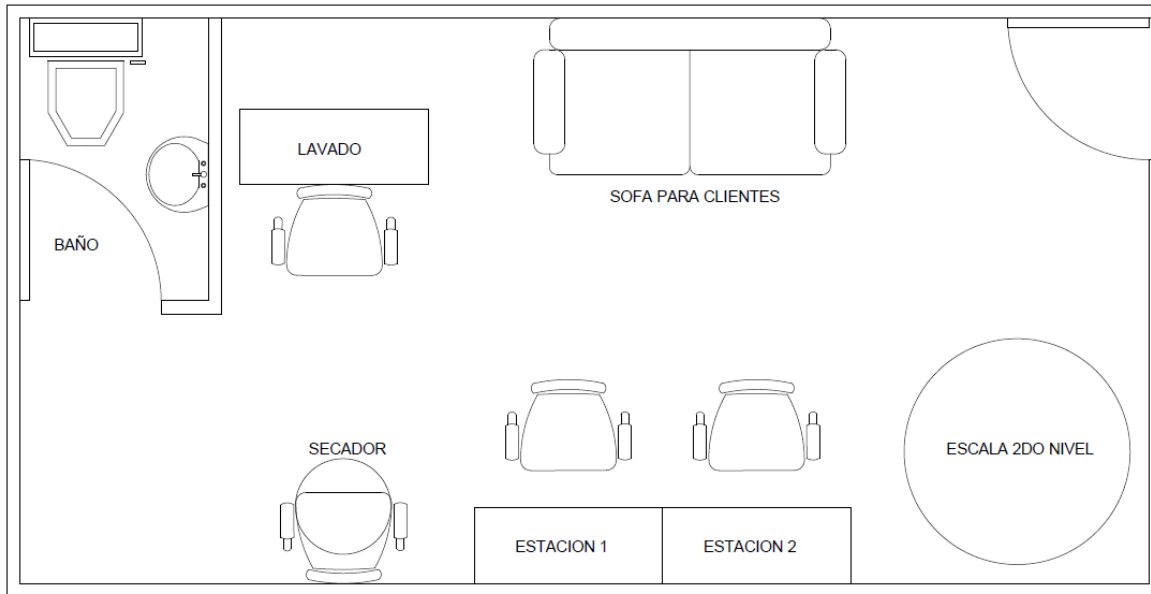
"Layout Primer piso Salón de Belleza (Fuente: Elaboración Propia)
